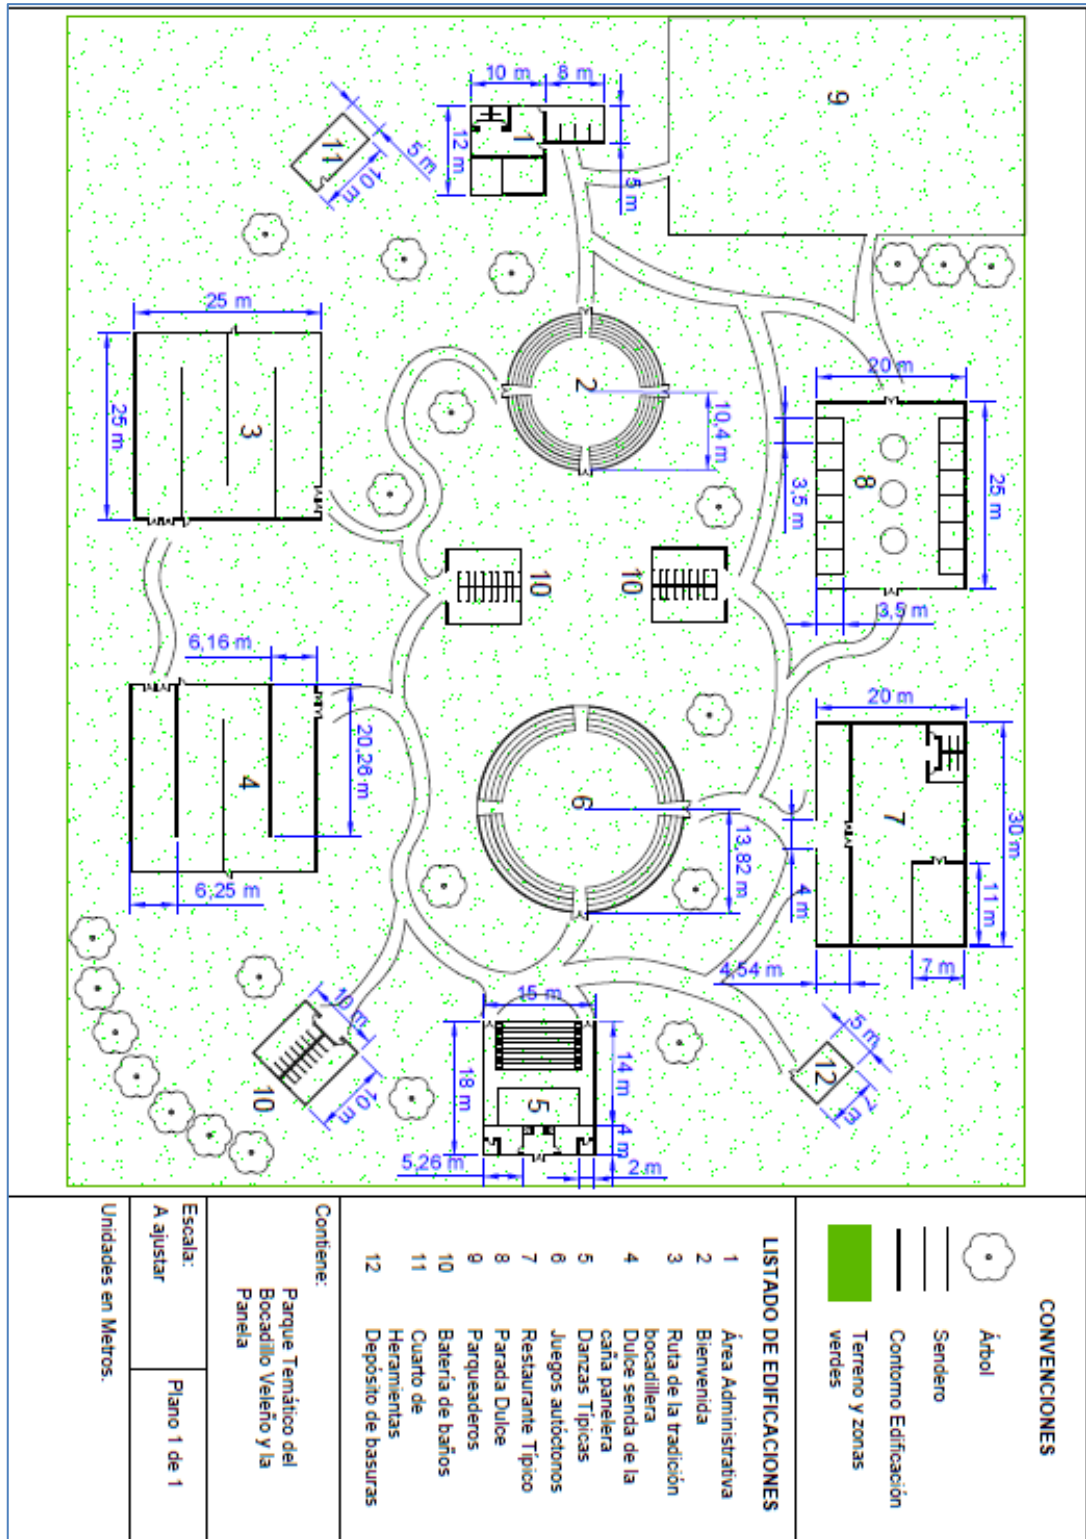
Distribución vista de la planta parque temático cultural del Bocadoleño y la panela
